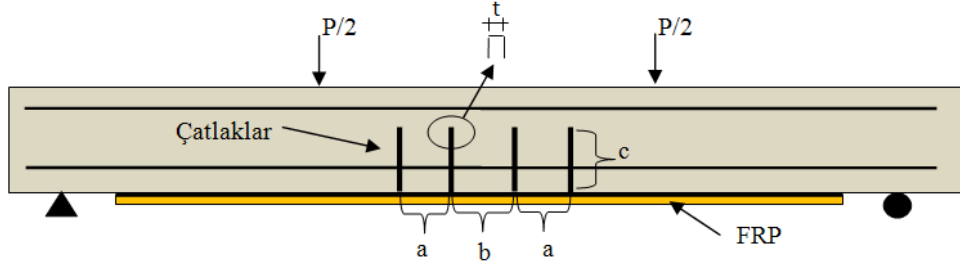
Dört nokta yüklemesi altında betonarme kirişlerde çatlak oluşumu
